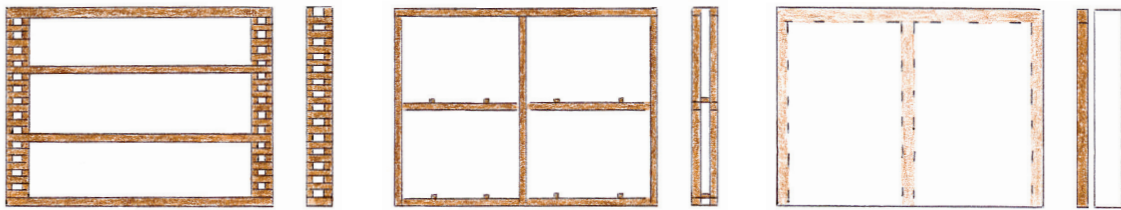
Elévations et sections : a) Maçonnerie avec éléments horizontaux en bois superposés en forme de pilier creux ; b) Maçonnerie avec éléments horizontaux et verticaux en bois ; c) Système à poteaux-poutres en bois associé à des murs en maçonnerie.
